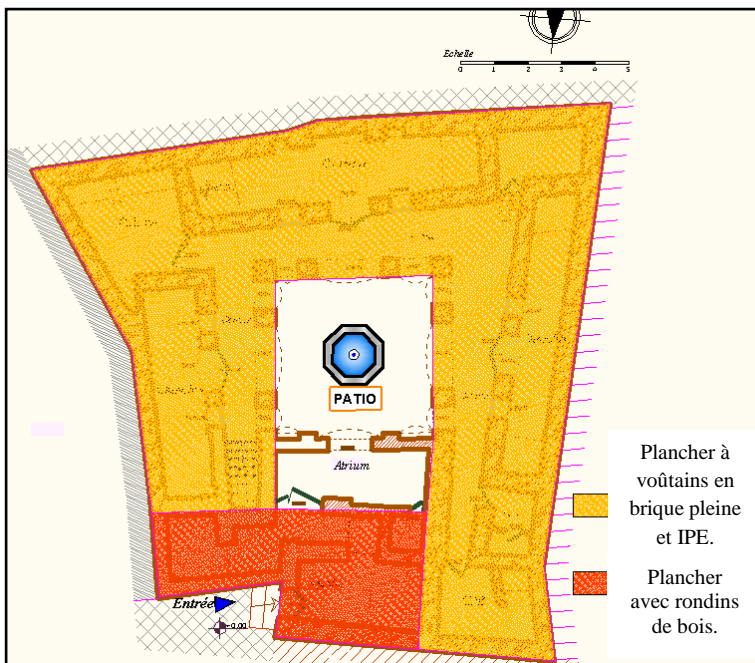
Situation des planchers au niveau du plan. Source : Auteur.
